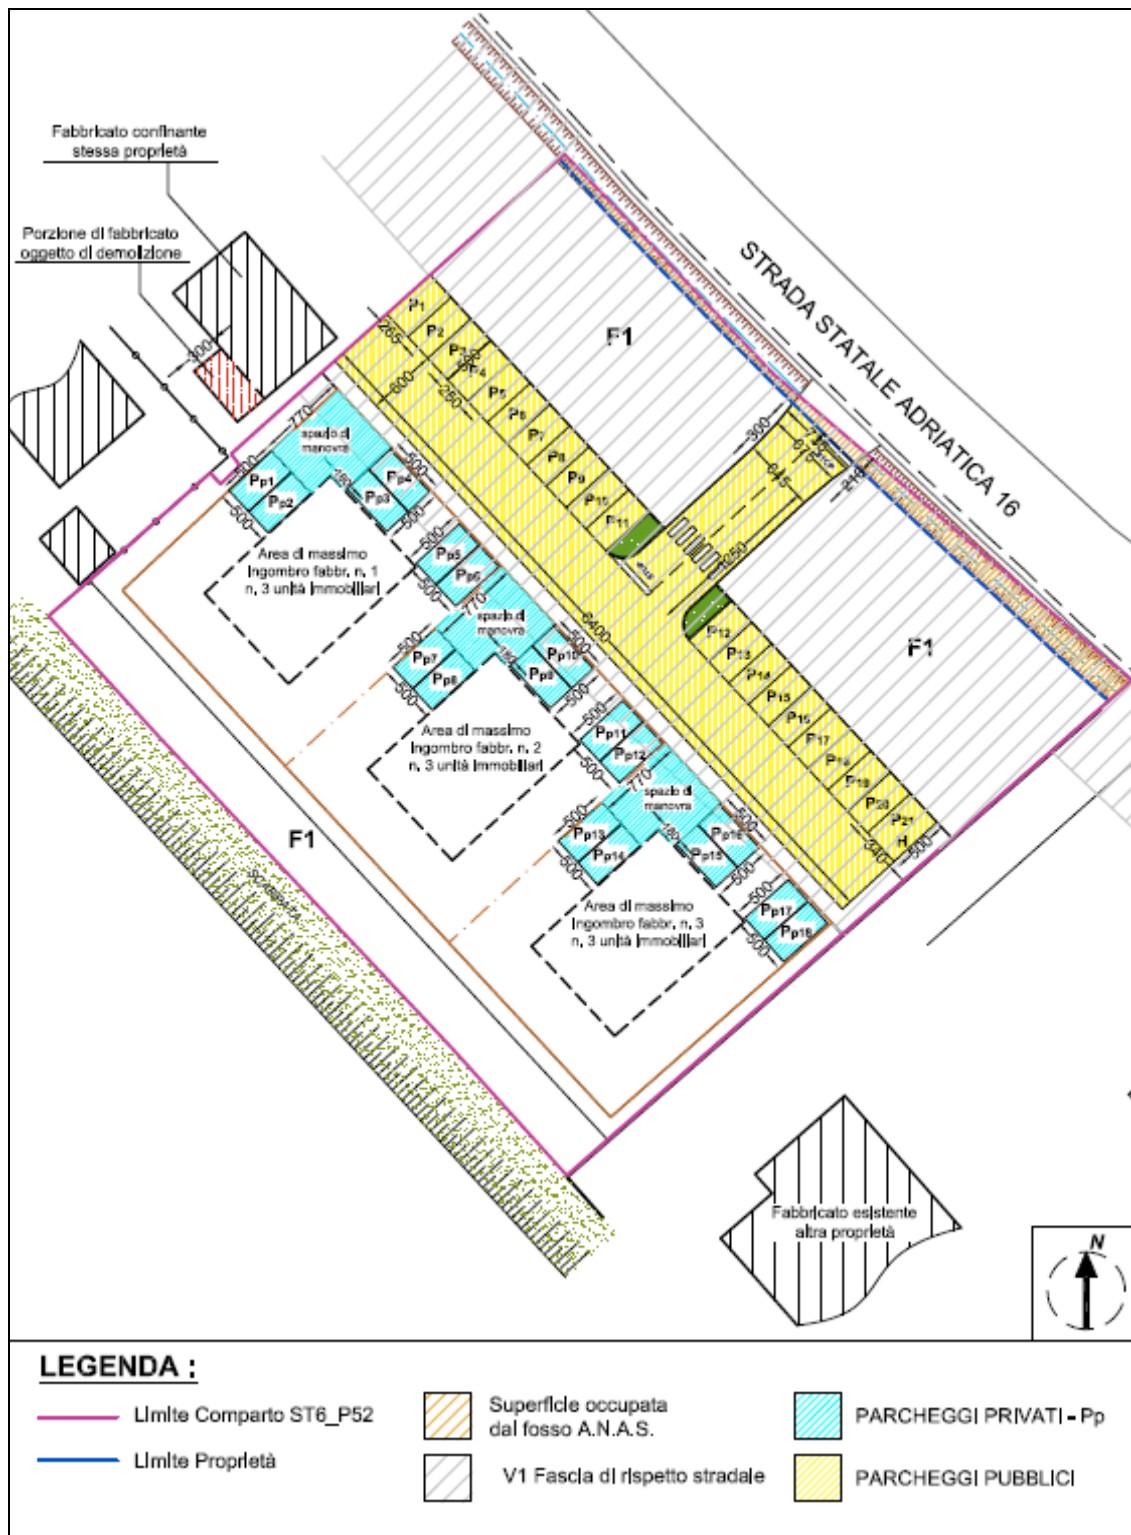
Planimetria con individuazione delle aree a parcheggio
